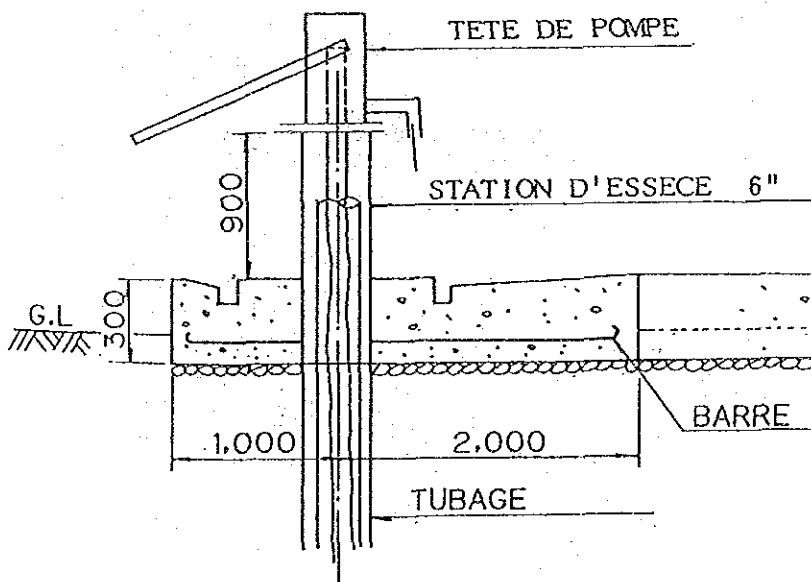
PLAN DE STRUCTURE DE LA MARGELLES
